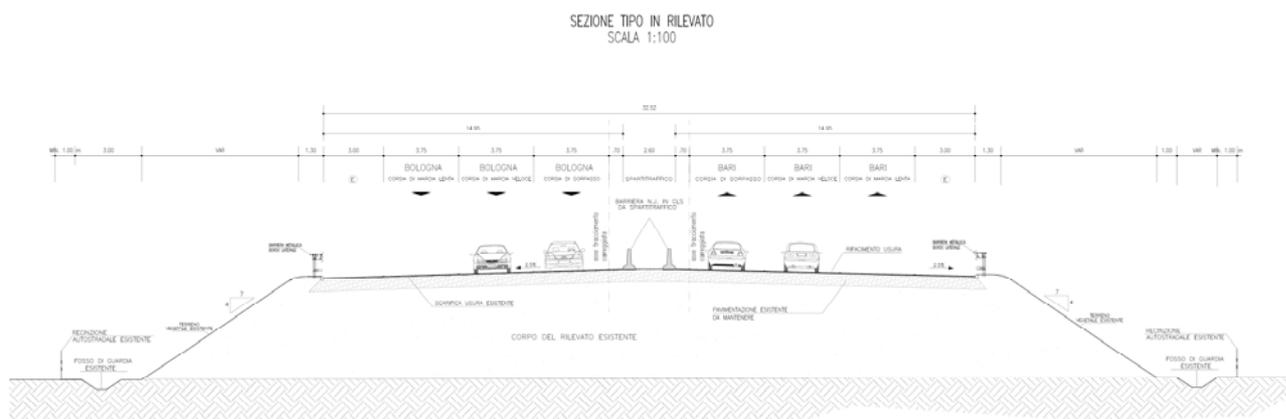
Sezione tipo in rilevato – tratto iniziale
